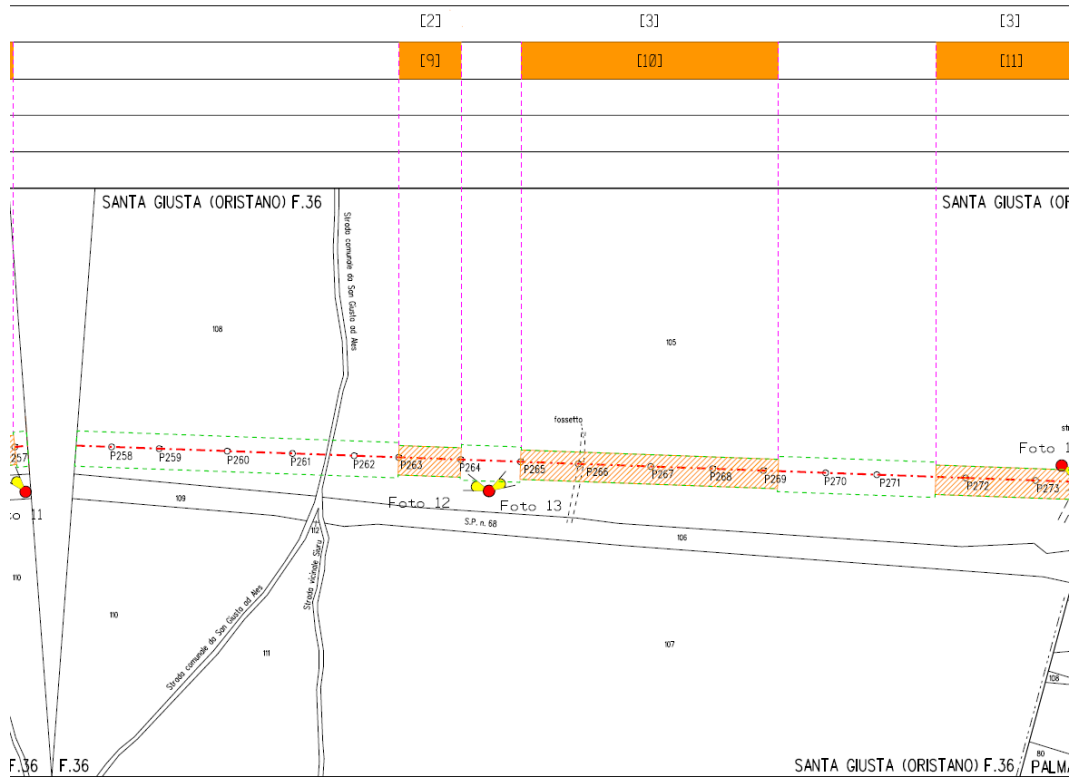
Tratto P263 - P264 - la zona delimitata dalle linee verdi rappresenta la fascia ristretta di lavoro per come previsto dalla GASD C 13.40.10.02
